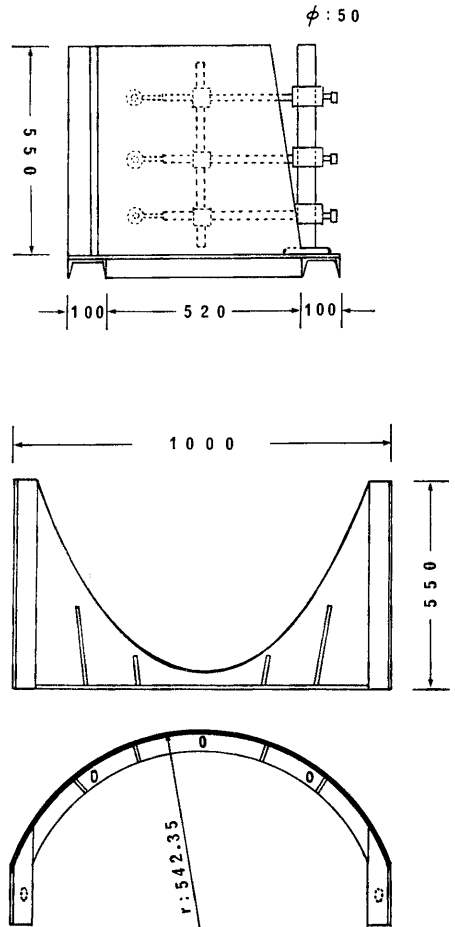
L'équipement des essais sur modèle, coupe transversale et la garniture.
